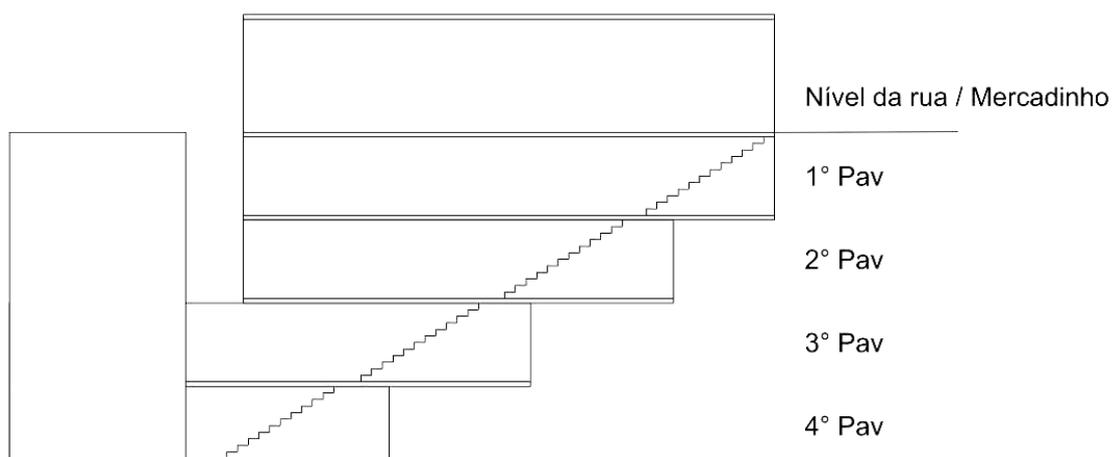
Esquema de elevação lateral do conjunto. Fonte: o autor
